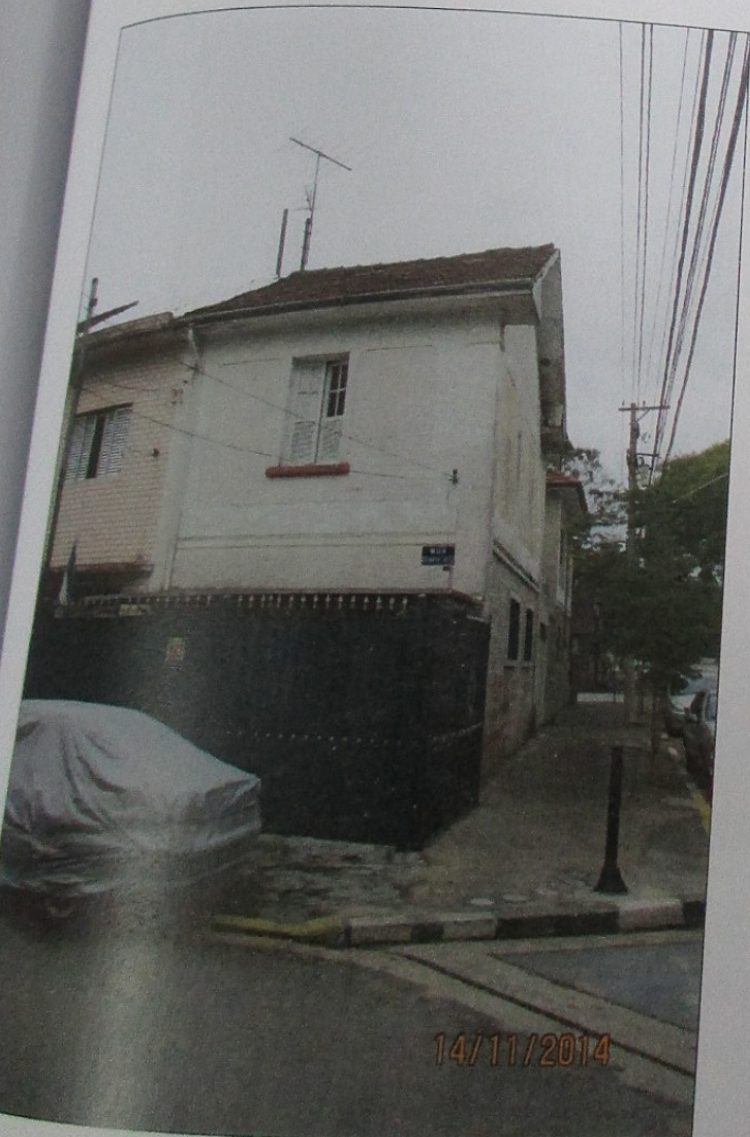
Vista porção frontal e de parte da lateral direita do imóvel objeto. Observar fechamento frontal em gradil metálico e elevada idade aparente da edificação.
